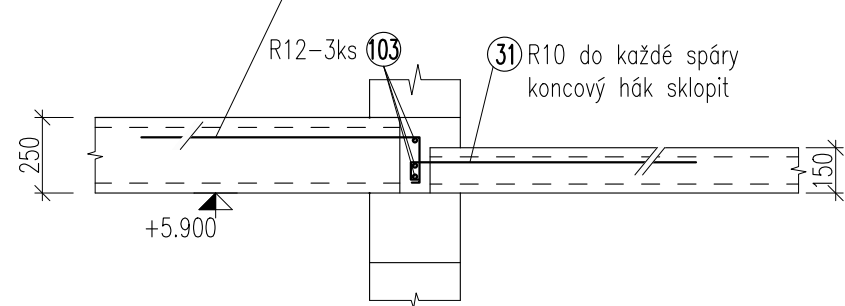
DETAIL PROVÁZÁNÍ KOLMÝCH VĚNCŮ A PRŮVLAKŮ
